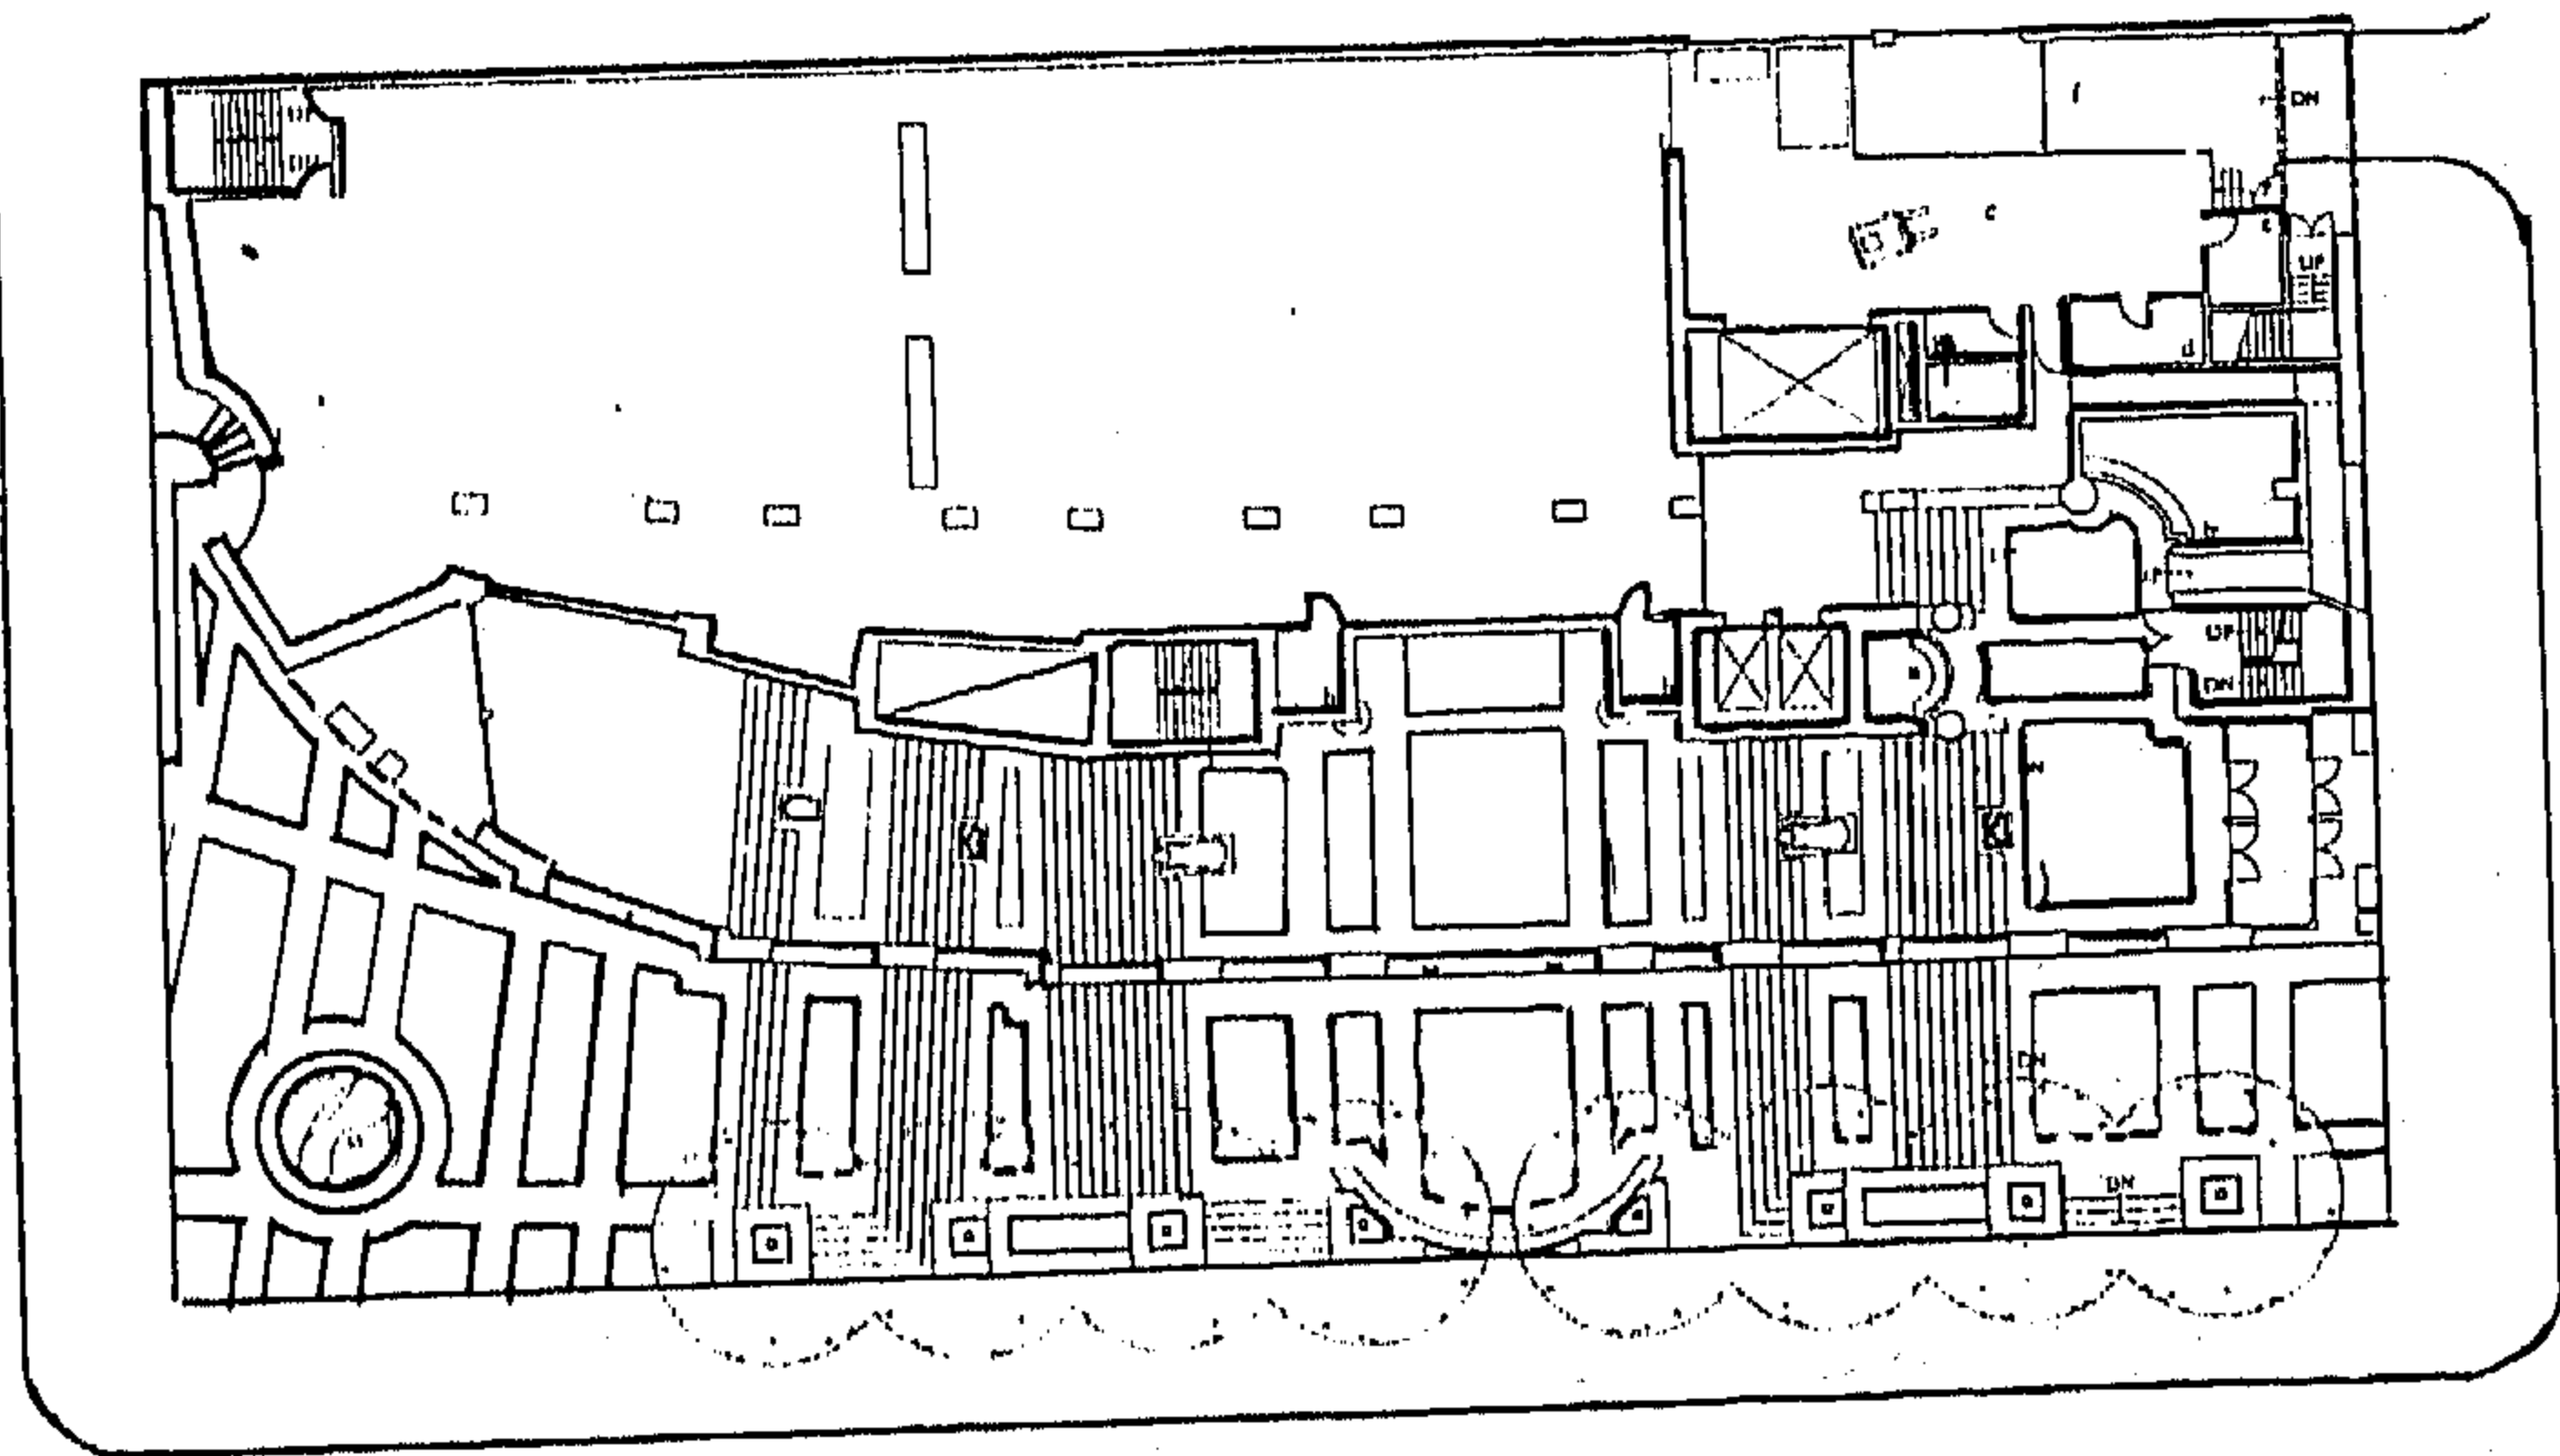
مسقط أفقي للطابق الأرضي
